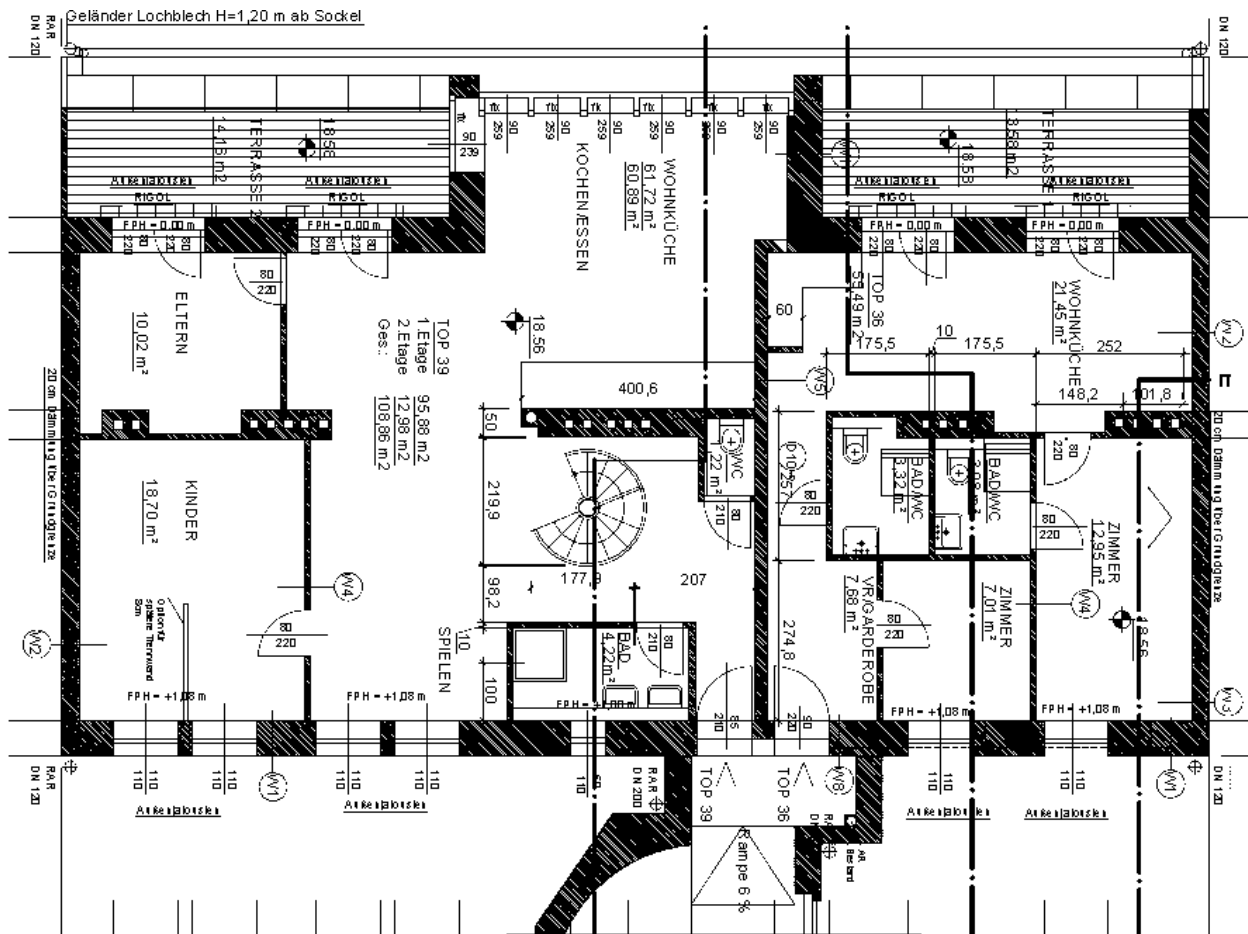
Grundriss des Dachgeschoßes – Straßenbrakt
